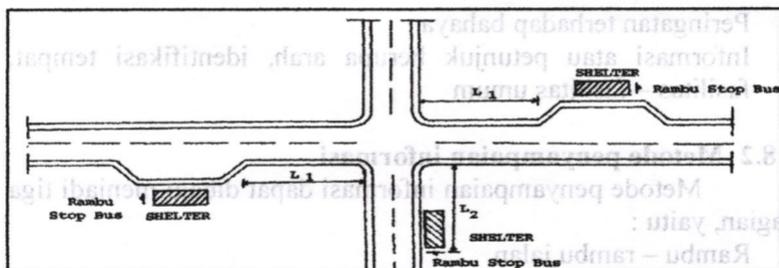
Bentuk tipikal Teluk Bus (Direktorat Bina Marga, 1990)
